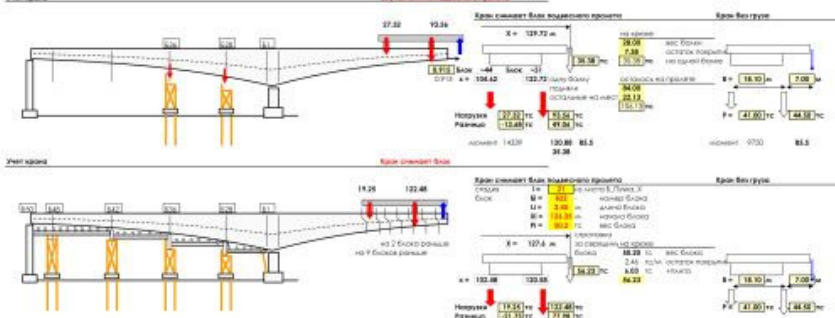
Расчетная схема демонтажа подвесного пролета
